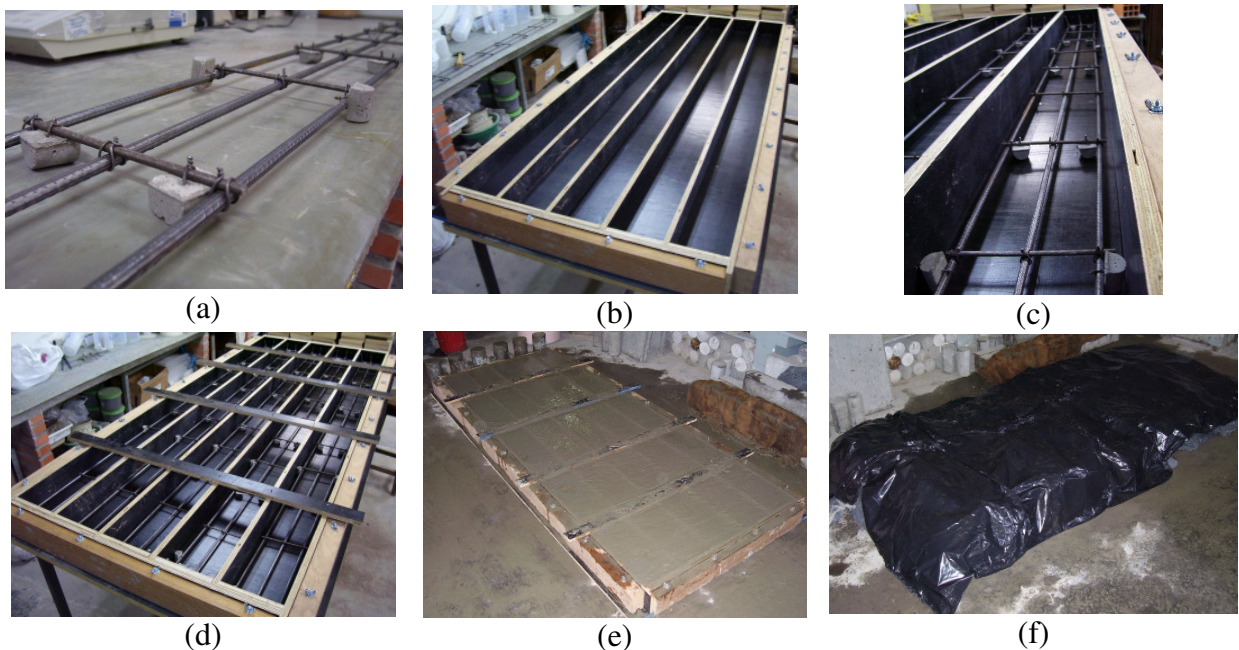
(a) armadura, (b) fôrma, (c) fôrma e armadura, (d) fôrma e armadura concluídas, (e) vigas concretadas (f) cura inicial.
